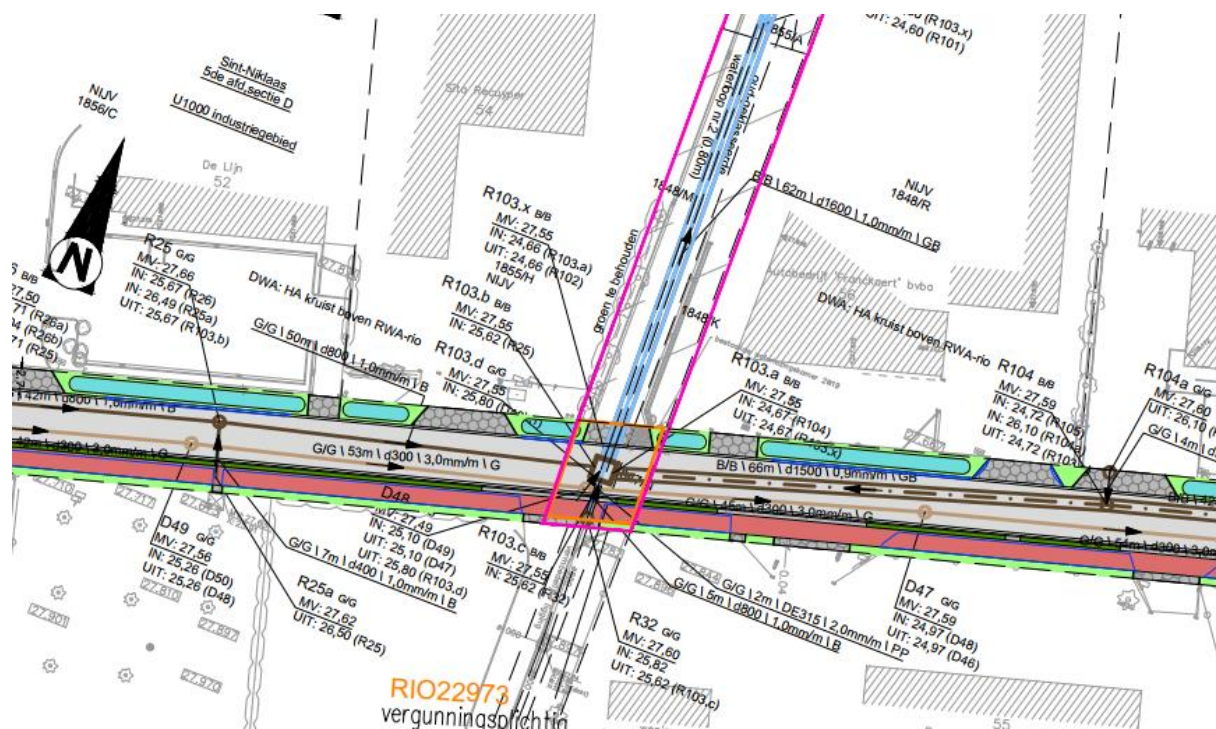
Uitsnede uit doorsnedeplan met bestaande toestand ter hoogte van Industriepark-West parallel aan de E17
